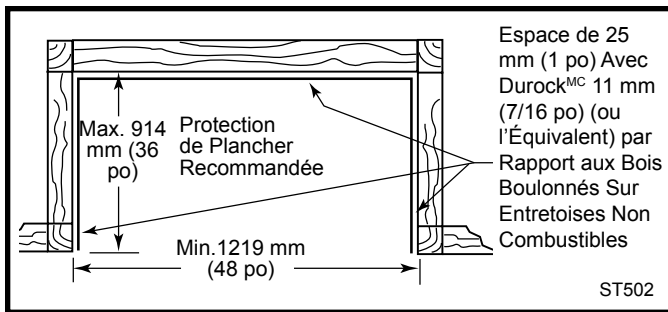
Plan de plancher avec alcôve. Panneau mural sur la face avant s'aboute au Durock^{MC} (ou l'équivalent) au-dessus du revêtement.
